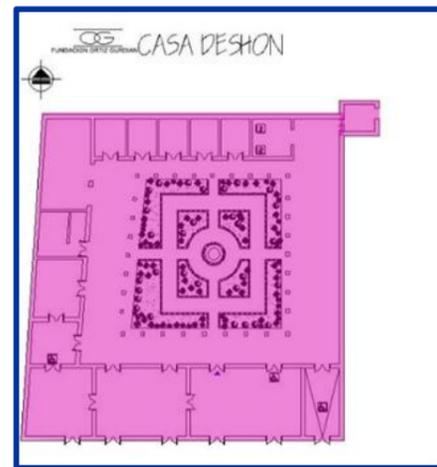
Plano Casa Deshon. Fuente: Propia
